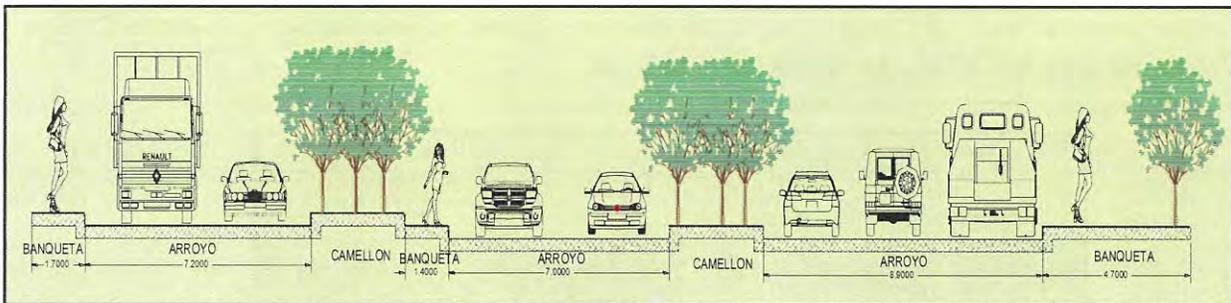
Sección Transversal Av. Fernando Alencastre y Av. Compositores. Fuente: PROYECO.
